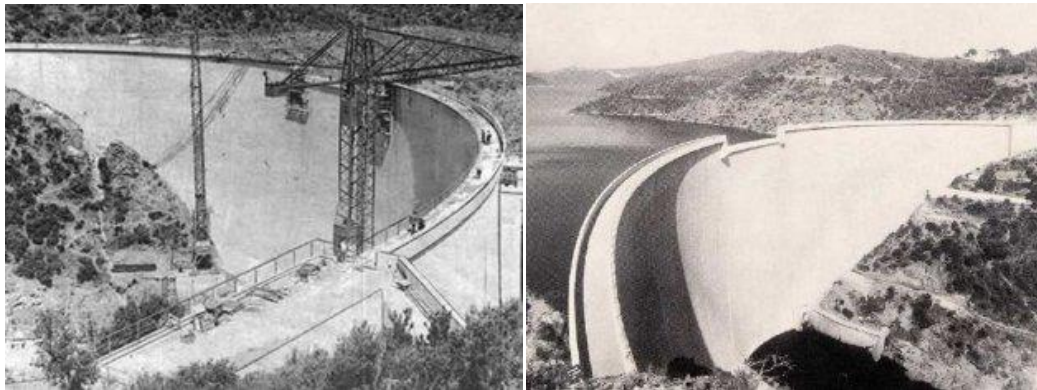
à gauche, le barrage au printemps 1959, au premier plan on observe la culée en béton constituant l'appui rive gauche de l'ouvrage. A droite, le barrage rempli (1959).
